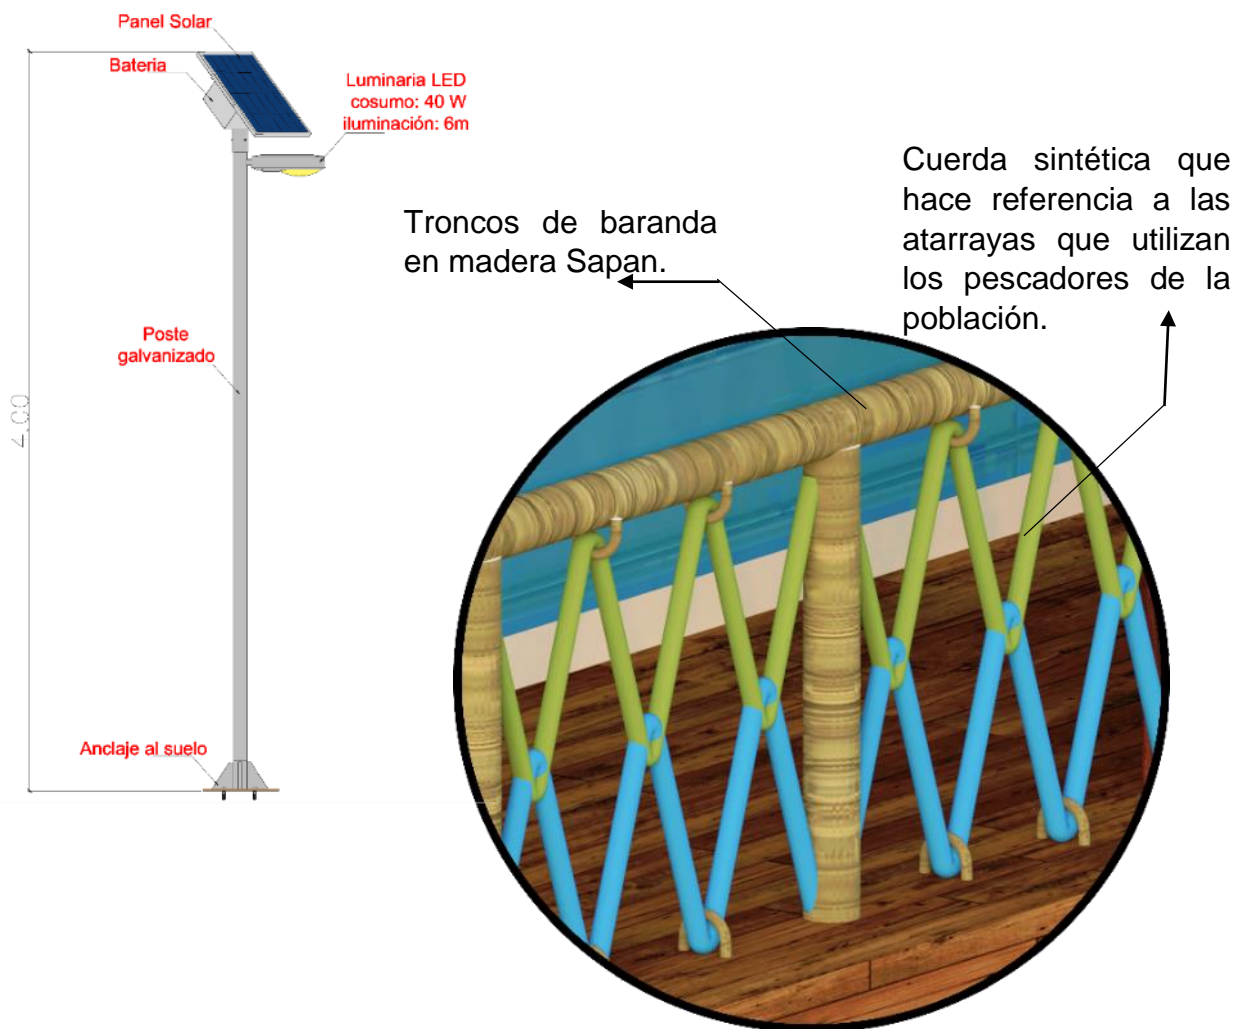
Detalle luminaria y barandas. Fuente: Elaboración propia.
